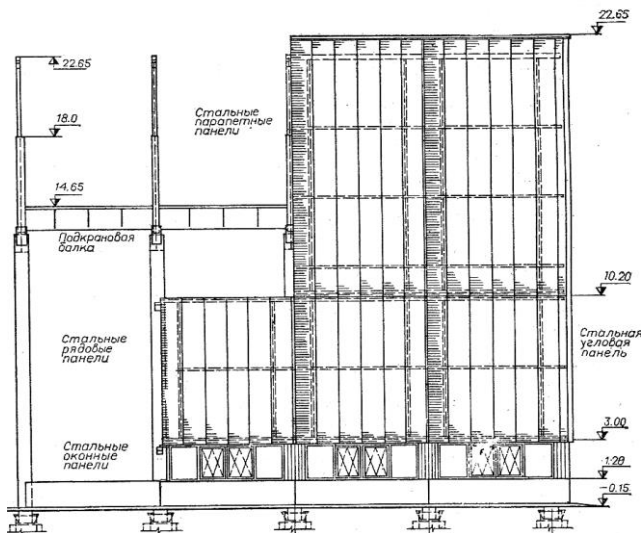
Стена из панелей «сэндвич» вертикальной разрезки
